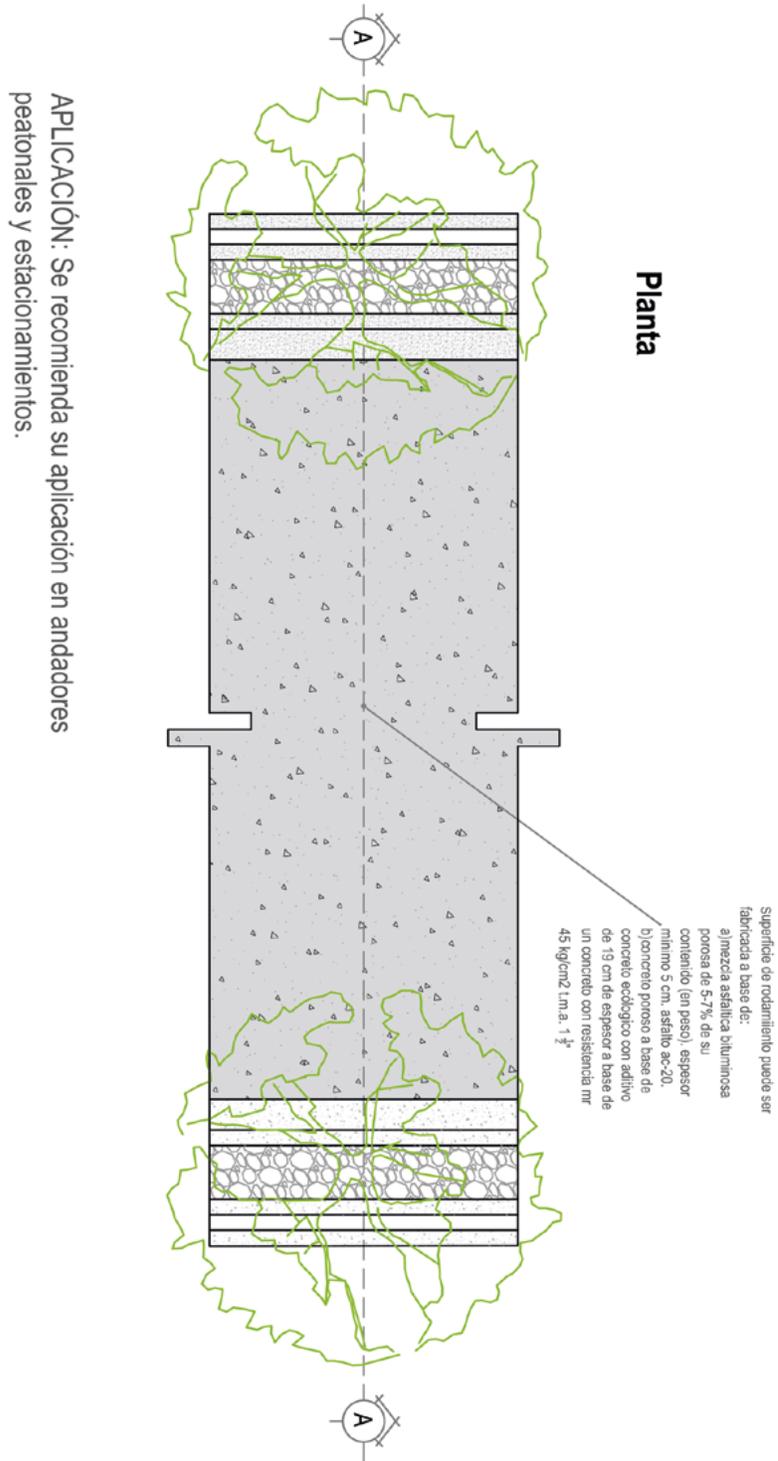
Detalle Constructivo de Pavimentos Permeables.
